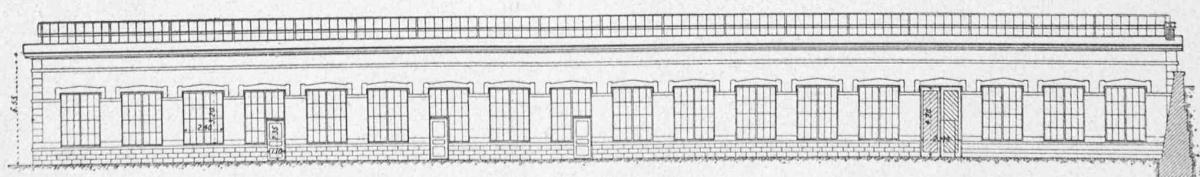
Ateliers des Tramways lausannois, en Prélaz. — Façade Nord. — Echelle : 1 : 400.
